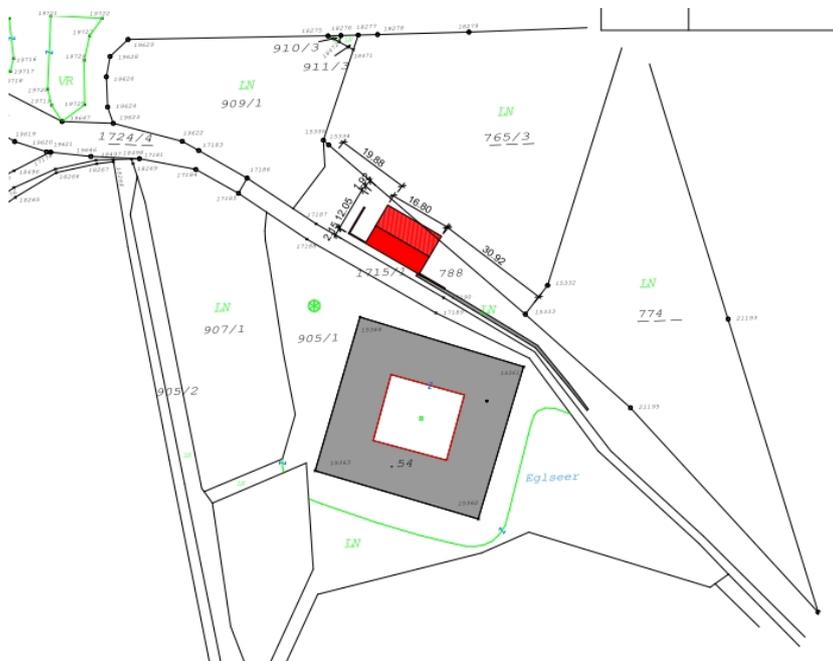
Lageplan bestehender Hof mit geplantem Stallgebäude in Rot, Planungsbüro Schatz KG
